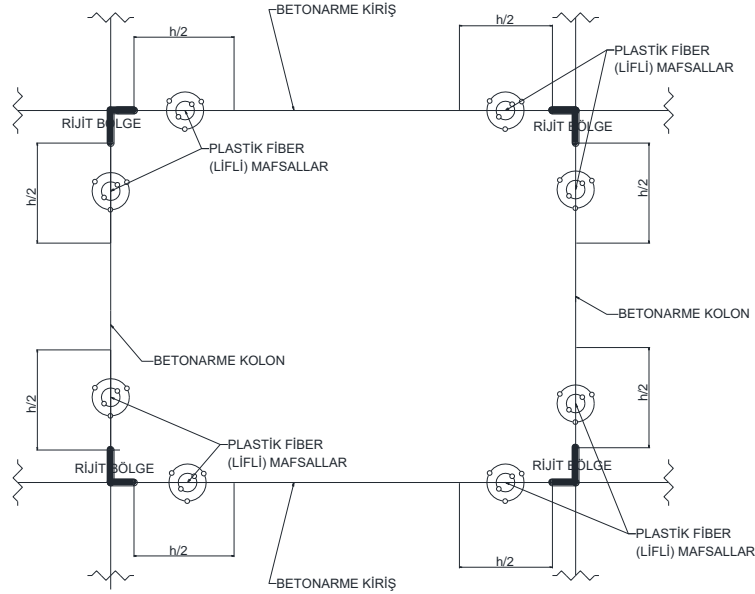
Çalışmada kullanılan kirişlere ait detaylar.
